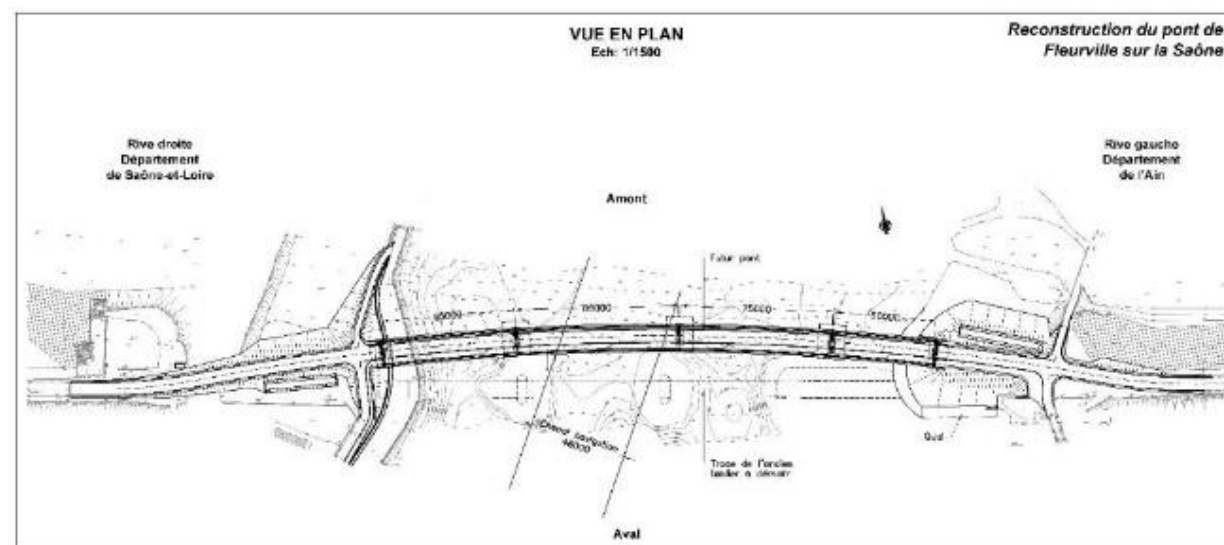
Vue en plan du projet de reconstruction du pont de Fleurville (source : PRO, 2018)
